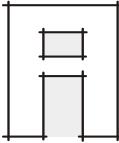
Lage Heizöltank und Grundwassermessstellen
